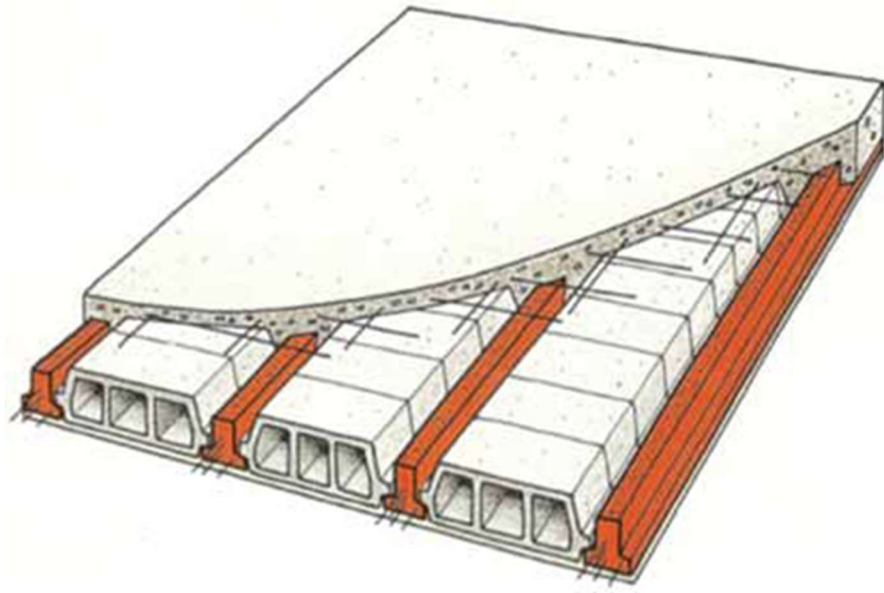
Ön Gerdirmeli Boşluklu Döşeme (Prefab.org.tr, 2023).
